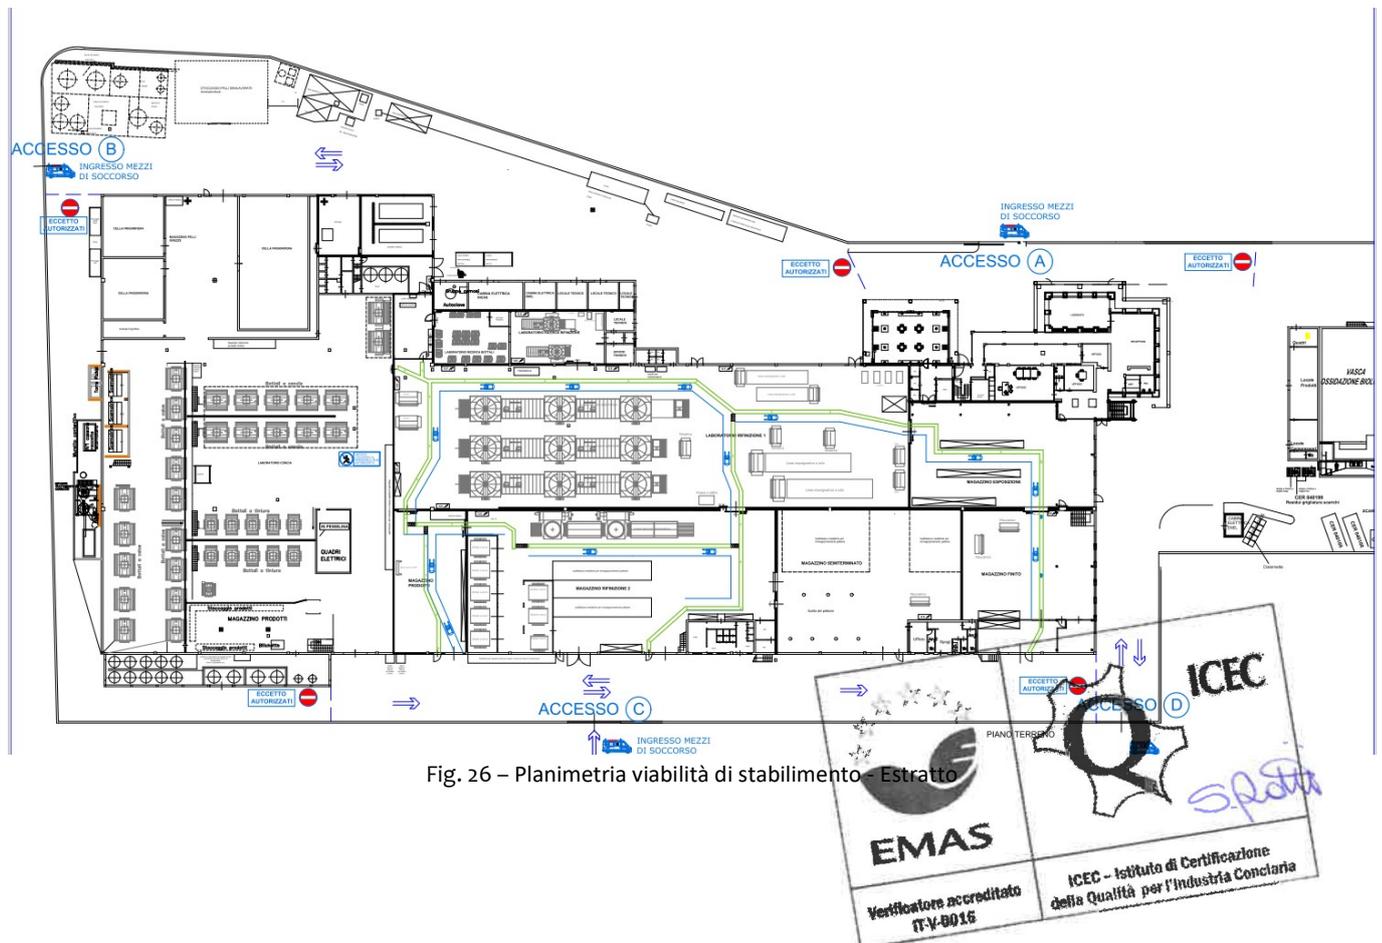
Planimetria viabilità di stabilimento - Estratto
